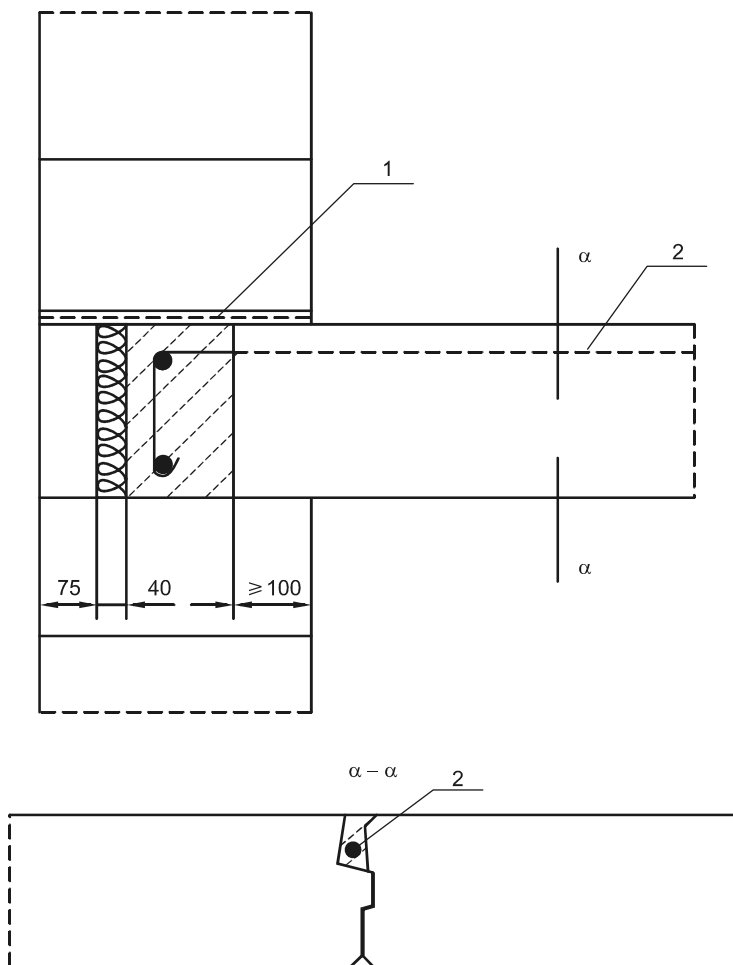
, б. Узлы сопряжения стен с панельными (б) перекрытиями:
